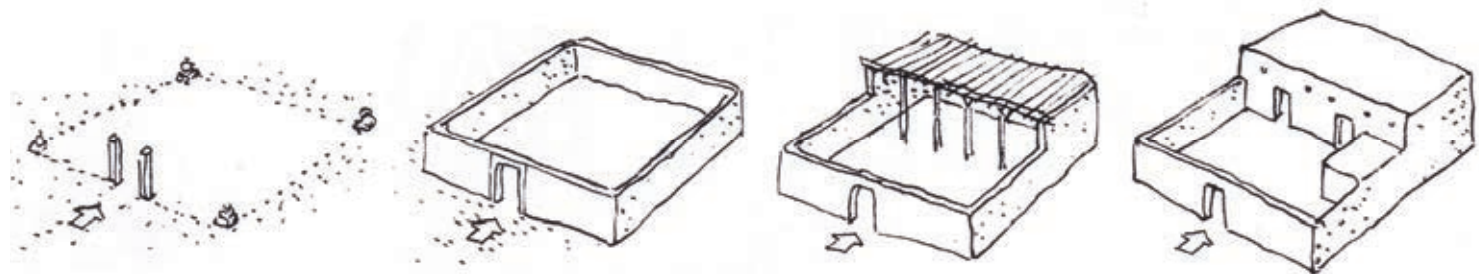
Wachstums-Schema des Hofhauses. – Festlegen der Grundstücksgrenze; Einfrieden des Grundstücks; Errichtung von überdachten Bereichen und Wohnräumen.
